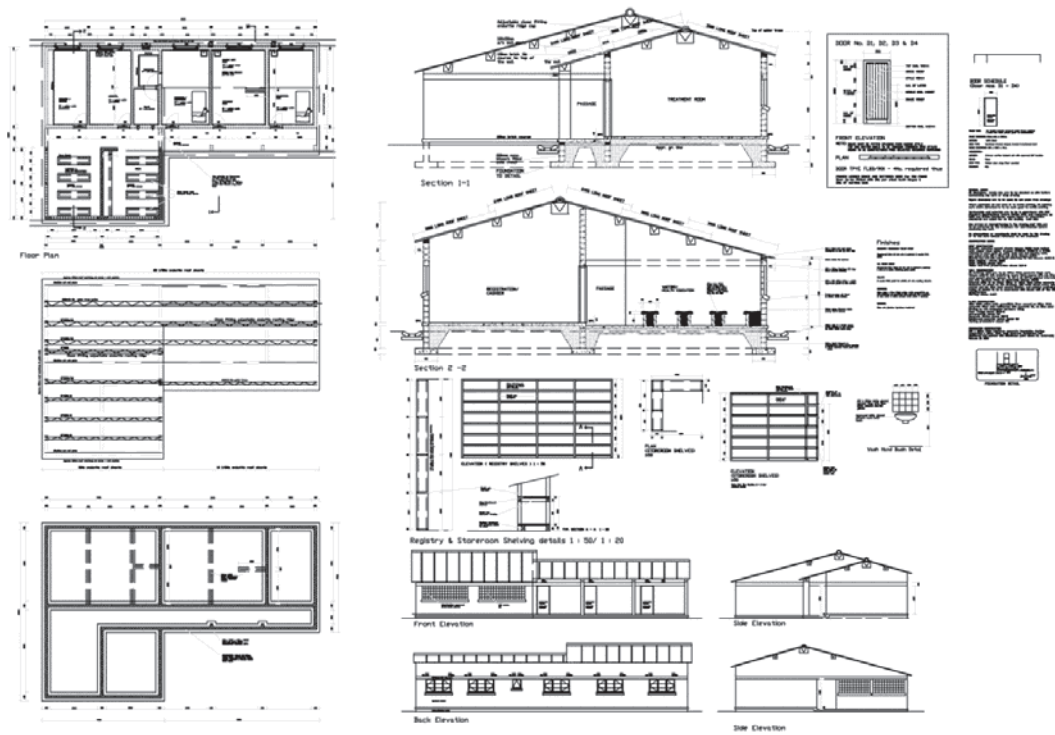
Health Centre 平面図・立面図 (OPD Block)
